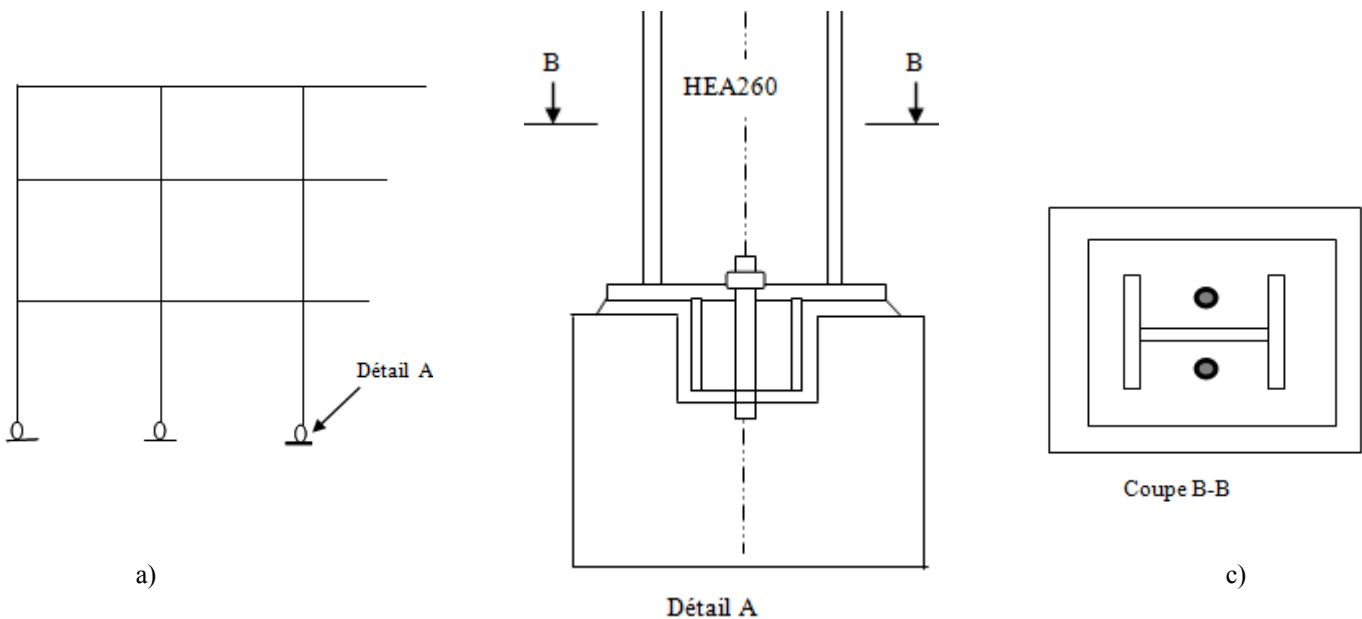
Structure métallique dont les poteaux sont articulés à leur base : a) structure métallique, b) détail de la base du poteau de rive , c) vue en plan du poteau.
